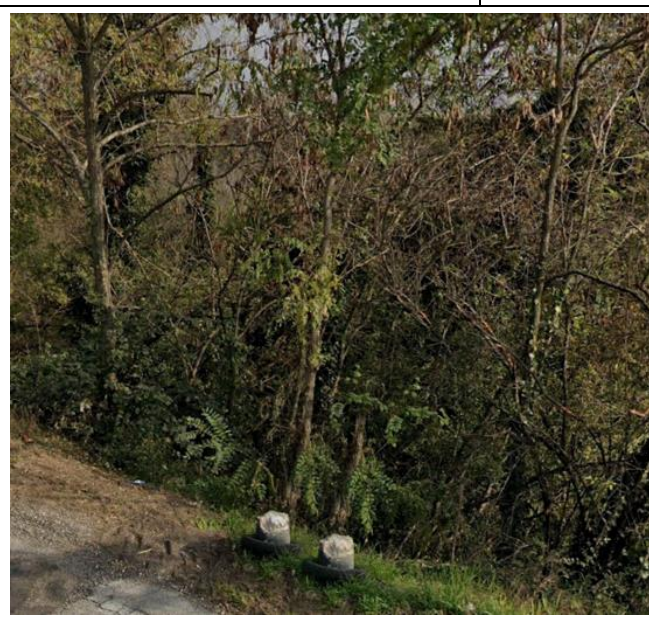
Localizzazione delle aree di cantiere lungo il tracciato ferroviario oggetto di intervento
